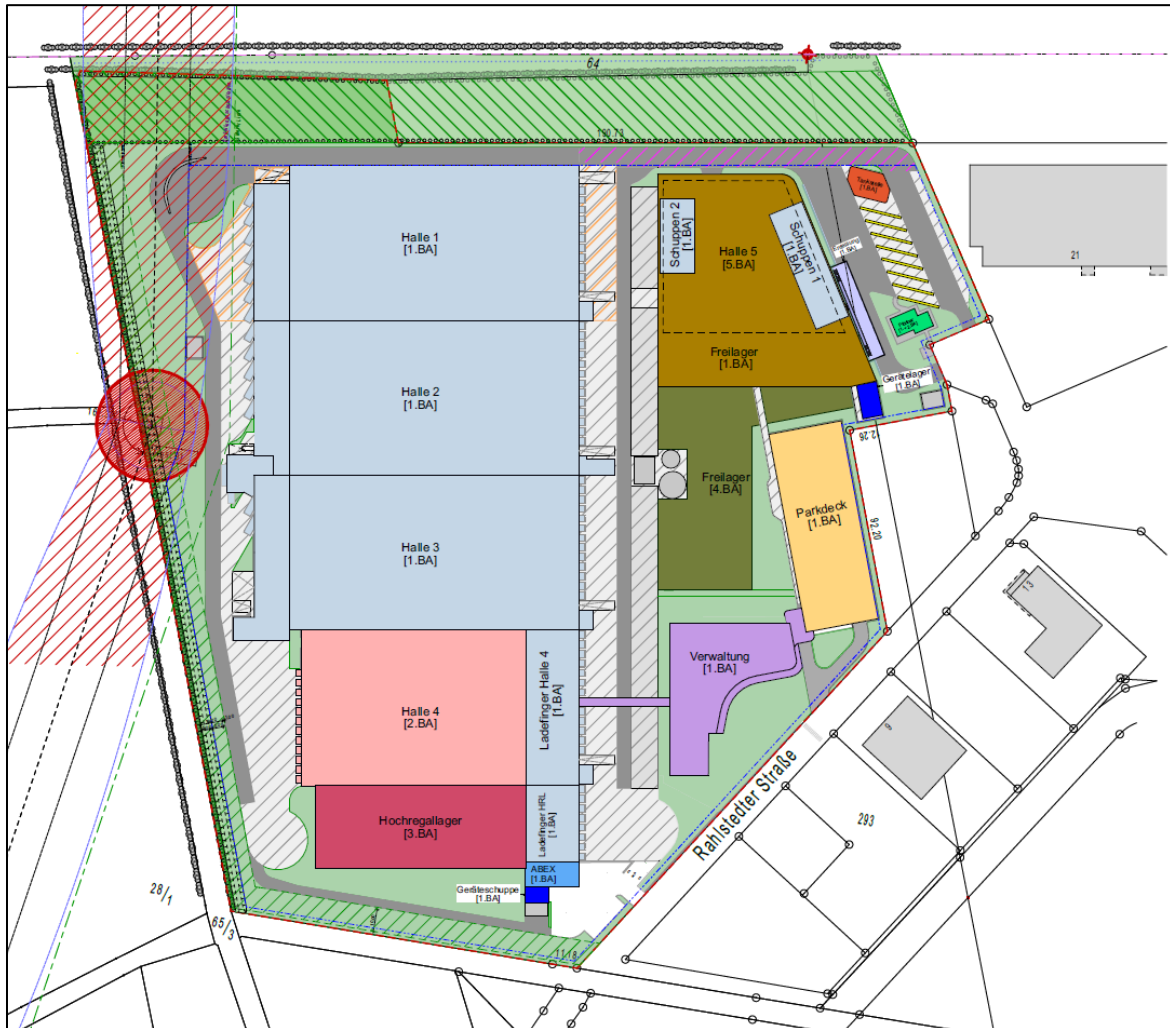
Strukturschema geplante Entwicklung; Quelle: INBAU, 18.02.2026
